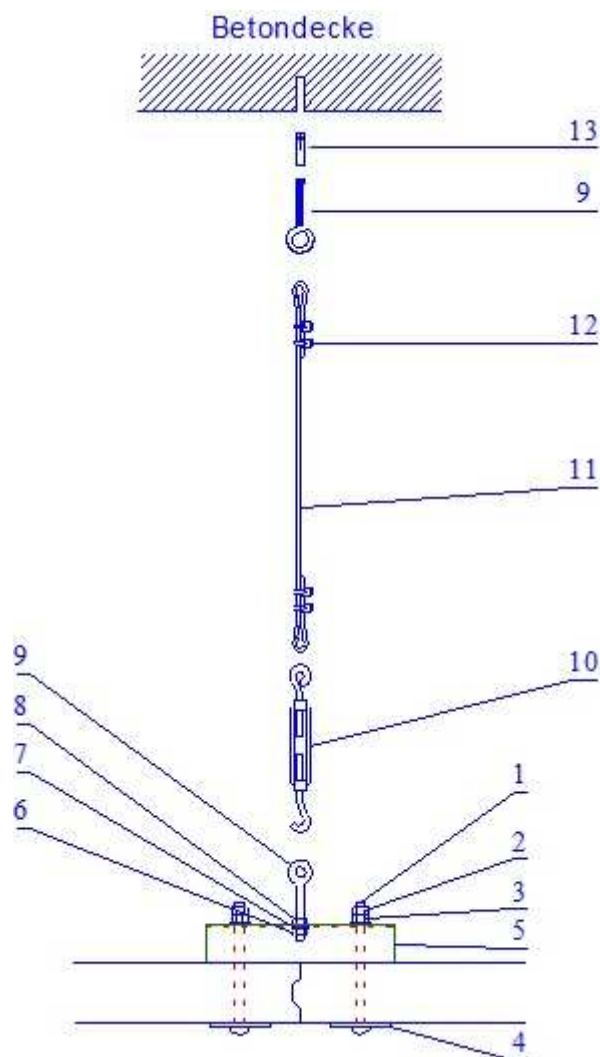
Beispiel: Schematische Darstellung Deckenabhängung in Betondecke
